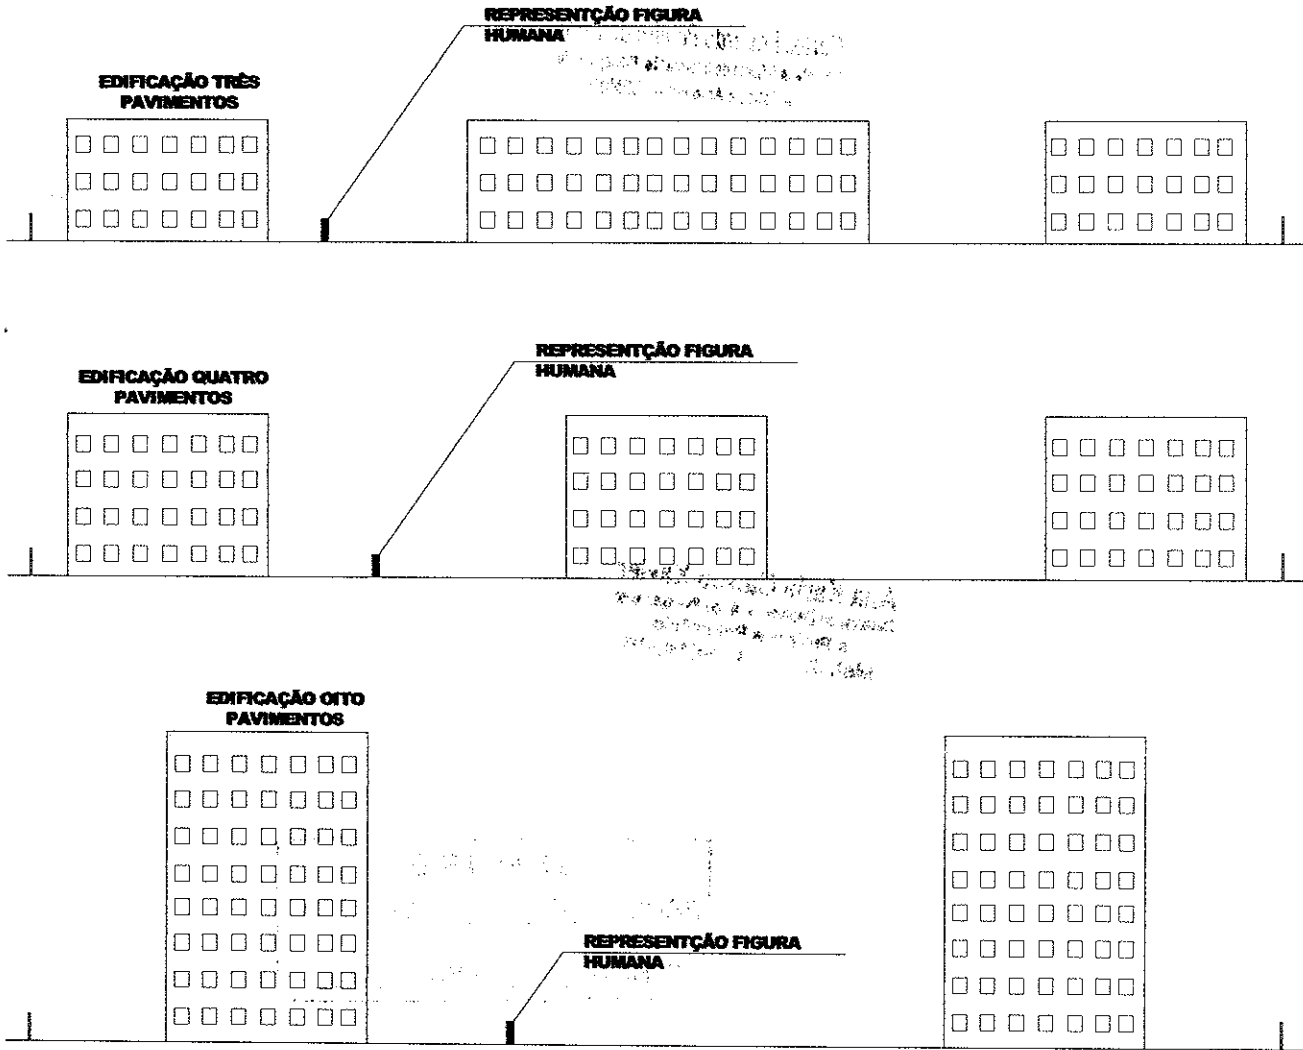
Elevação com situações paisagísticas de edificações com gabaritos de 03, 04 e 08 pavimentos no terreno em estudo
